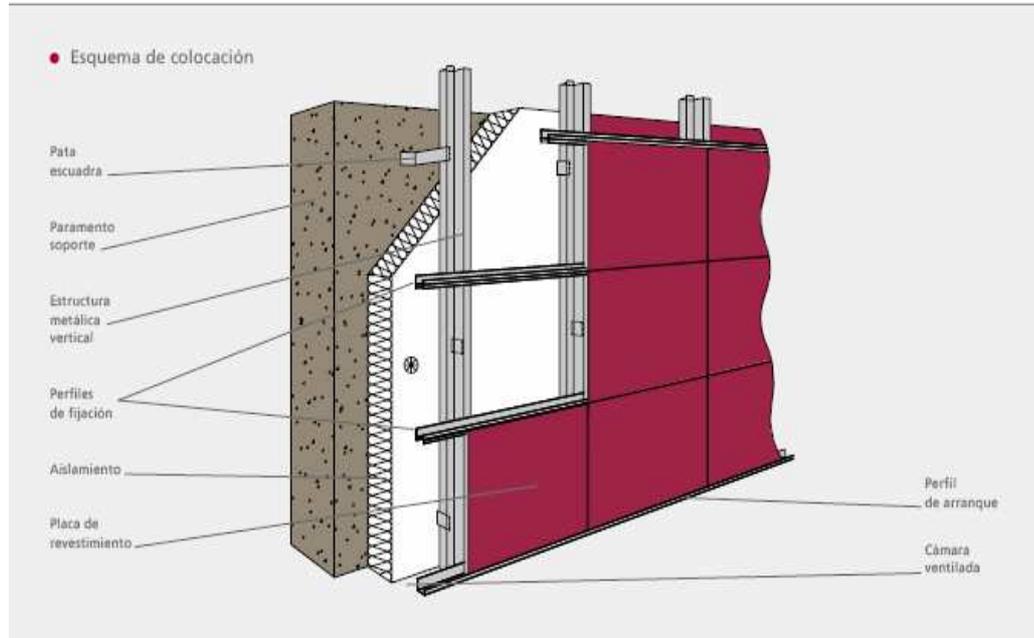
Colocación de placa de revestimiento sobre estructura de perfiles de fijación secundaria.
